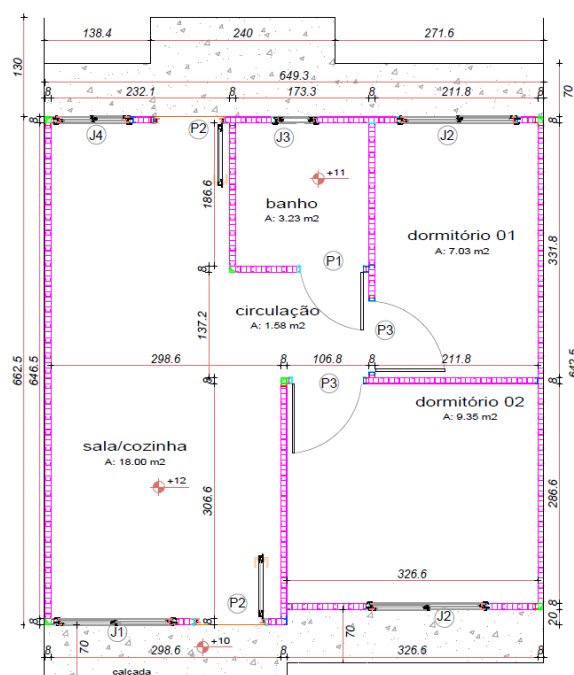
Planta da edificação do Loteamento Popular Nova São Paulo, em Sapiranga/RS.
